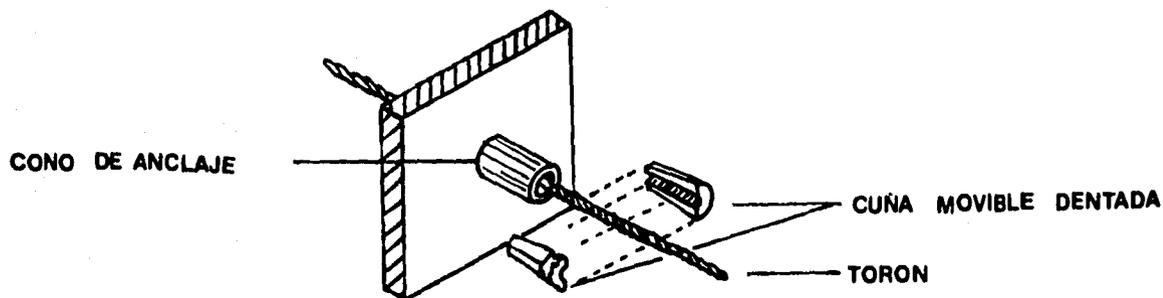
ANCLAJE PARA PRETENSADO
